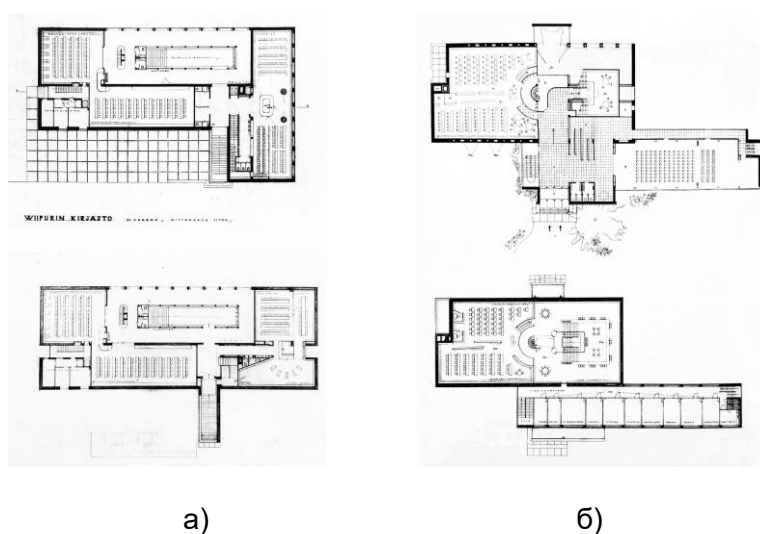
План библиотеки в Выборге, арх. Алвар Аалто: а) первый вариант плана здания 1929 г.; б) план первого и второго этажей 1933 г.
